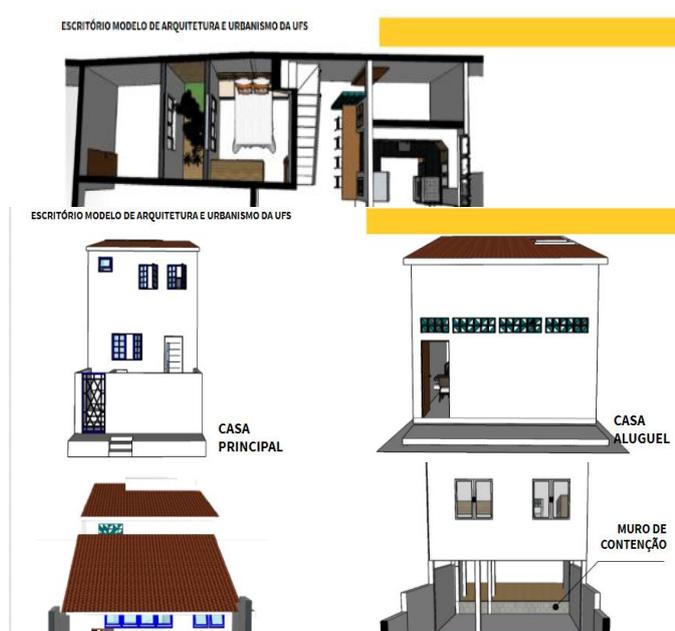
Maquete eletrônica da casa do Aislan – layout interno. Fonte: Trapiche, 2019.
